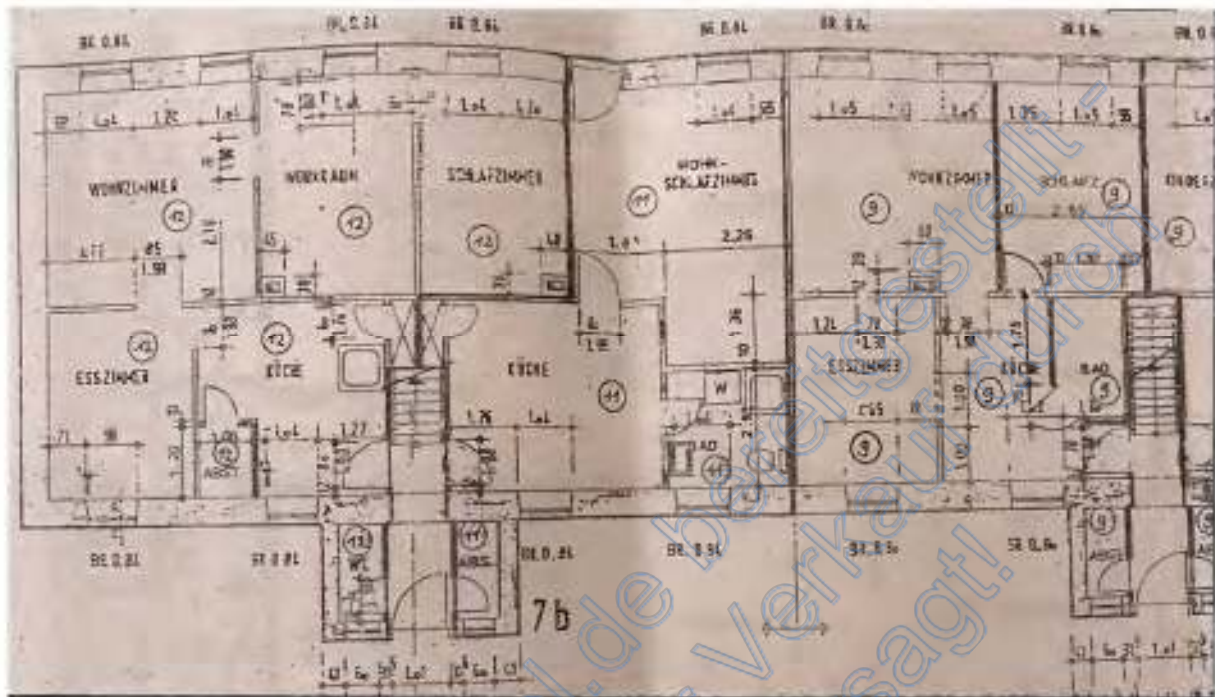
Hauseingang 7B hofseitig mit Grundriss der Erdgeschoss Wohnung 11.
